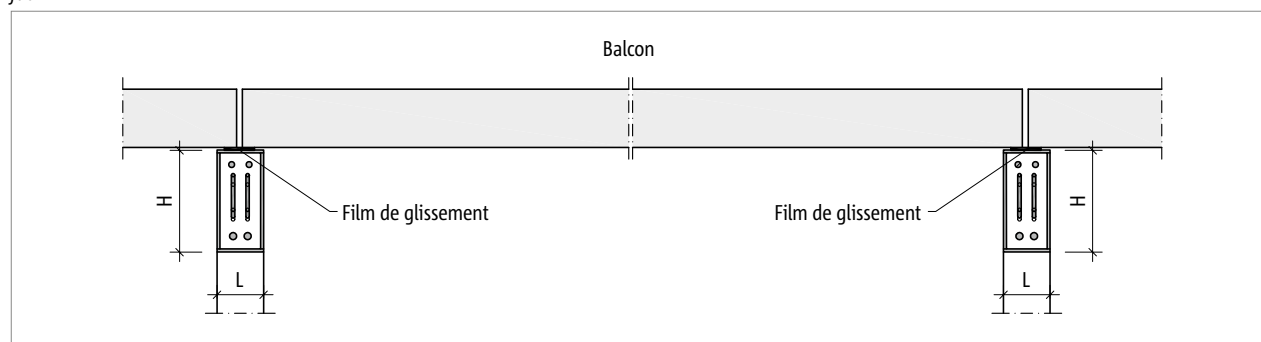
Schöck Isokorb® T Type B : Coupe ; Résistance à la fatigue grâce au film de glissement entre les dalles de balcon et les poutres en porte-à-faux
